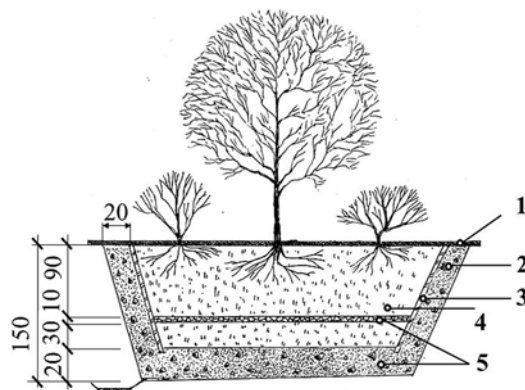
Способ создания групповой посадки в многолетнемерзлых грунтах в котловане или в траншее:
